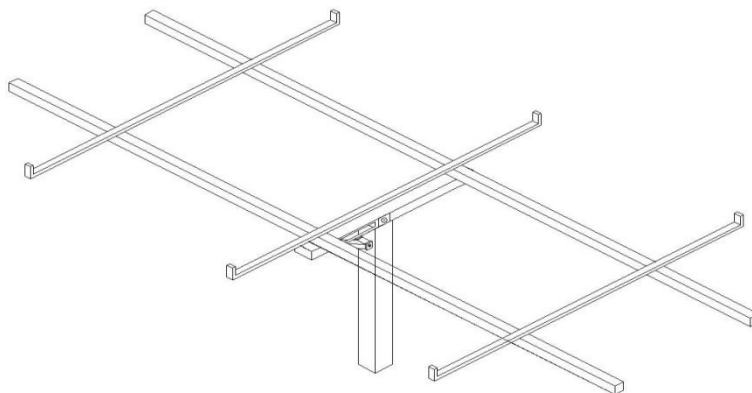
7 Soportería Típica para montaje de paneles fotovoltaicos
